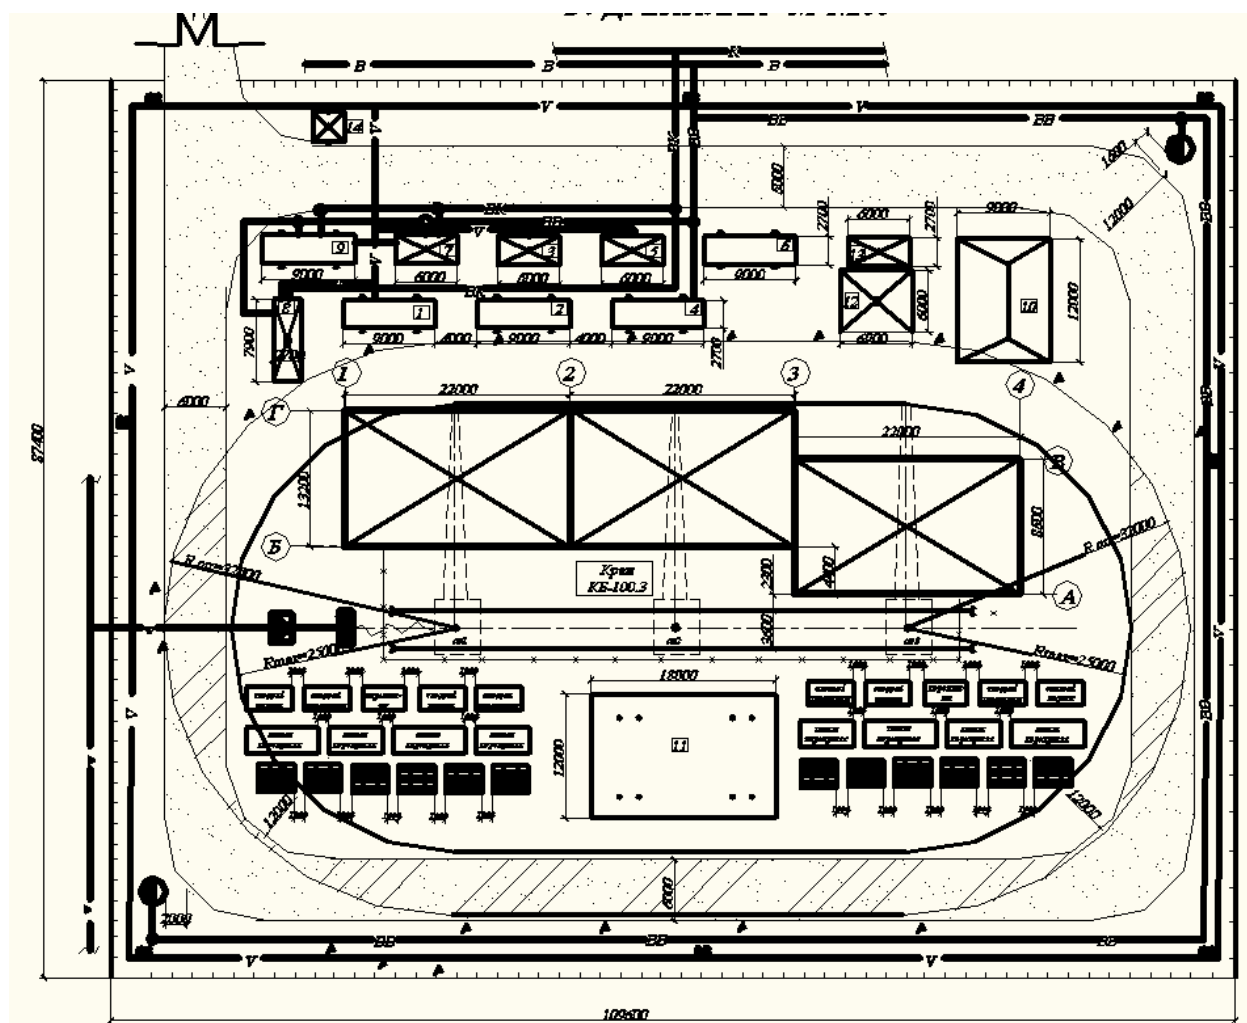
Приклад будгенплану будівництва житлової трьох секційної багатоповерхової будівлі
